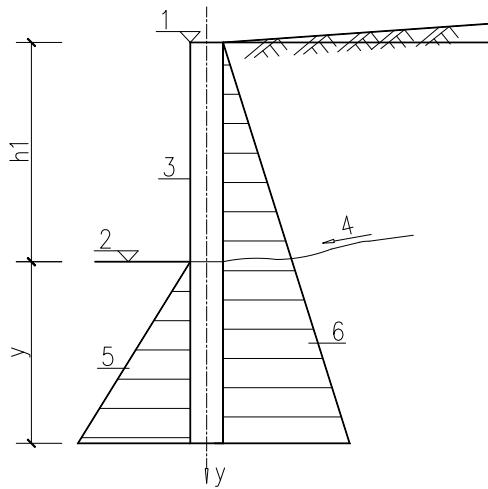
悬臂排桩土质横向承载力特征值计算简图
